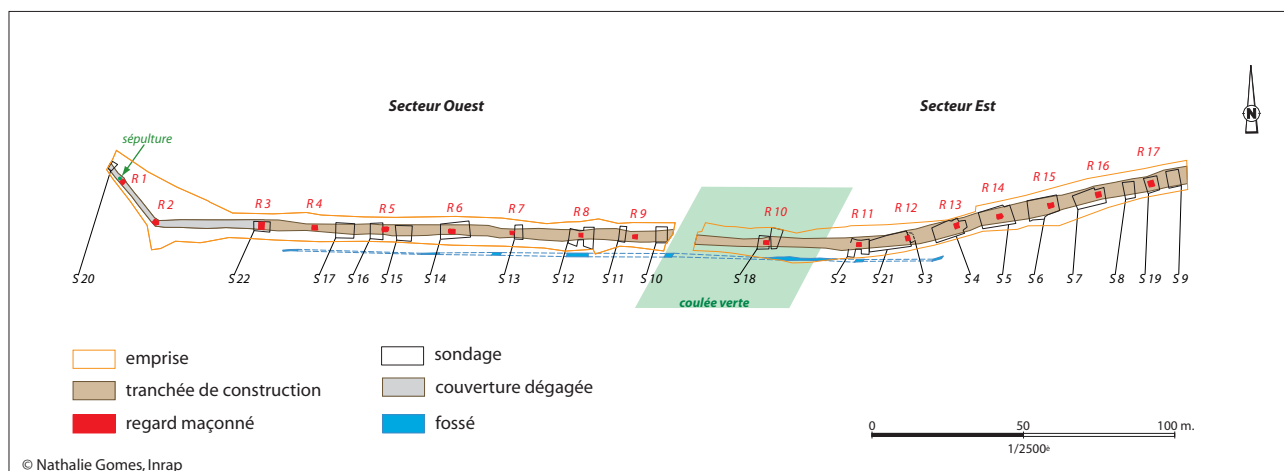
Plan général de l'aqueduc de Villenoy sur la fouille du Parc d'Activités du Pays de Meaux (Nathalie Gomes, Inrap).
